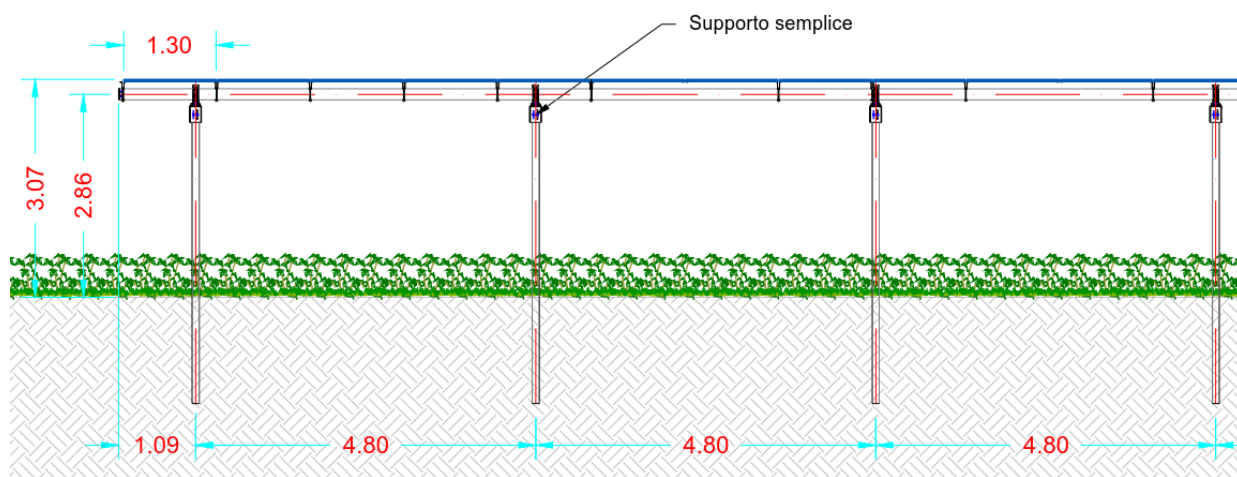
Sezione longitudinale tipologica struttura Tracker – Area 05
